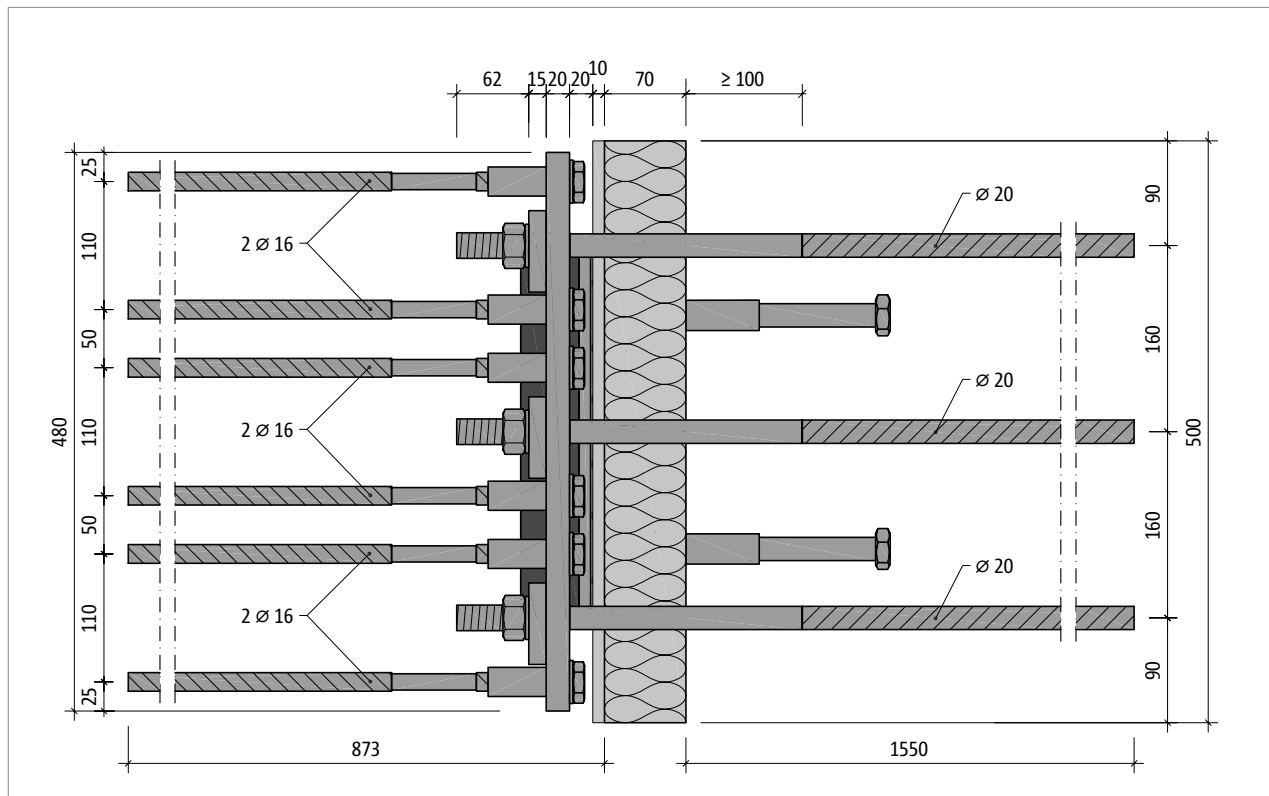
Schöck Isokorb® IQ Typ K-B: Produktgrundriss
